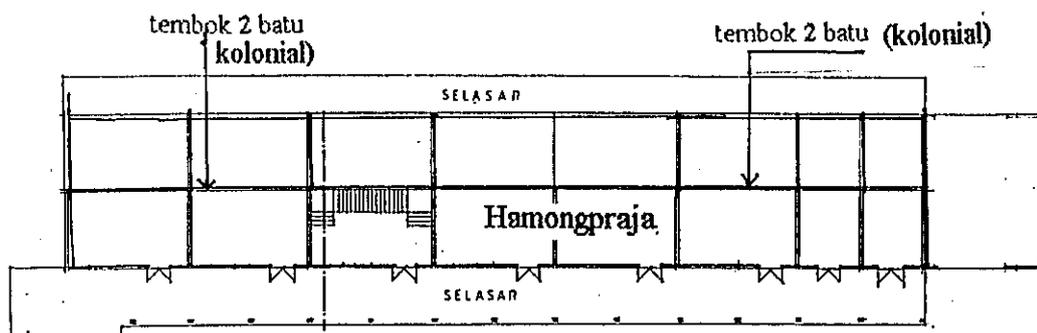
Denah Hamongpraja bentuk memanjang (linier), terdiri dari banyak ruang berjajar memanjang (Aspek fisik Arsitektur Kolonial Belanda)
